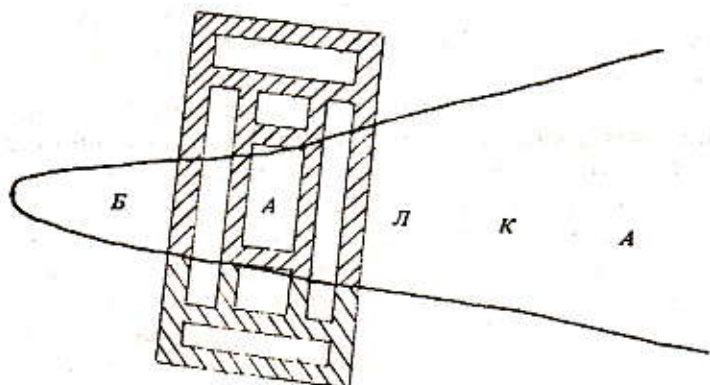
План слоистого сплошного фундамента под храм Аполлона в Ольвии
